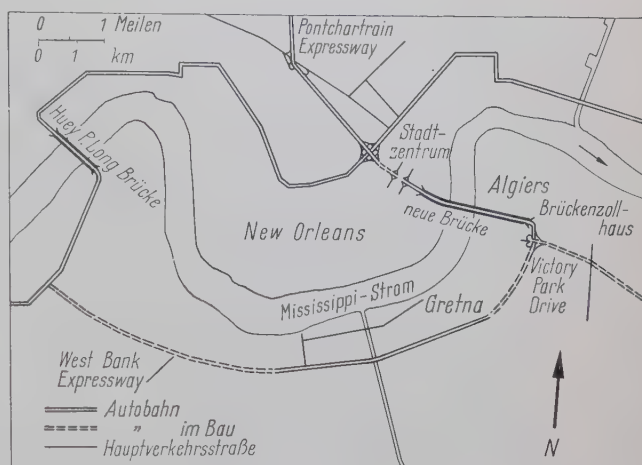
Lageplan der Stadt New Orleans mit der neuen Straßenbrücke über den Mississippi
